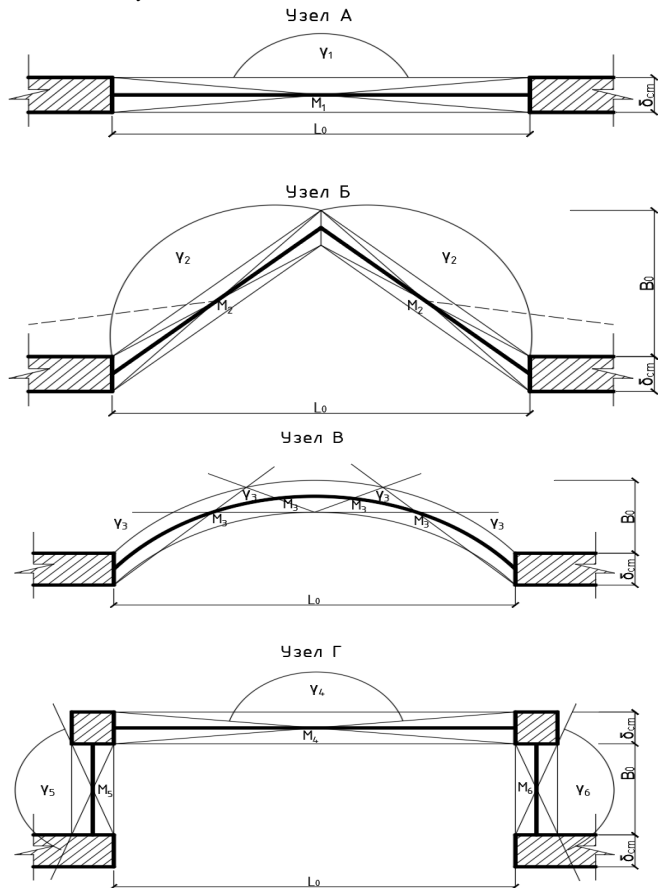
Узлы А, Б, В, Г конструкций боковых светопроемов естественного света: L_0 - длина (ширина) остекления; B_0 - вынос конструкции эркера относительно наружной стены; $\delta_{см}$ - толщина наружной стены; M_1-M_6 - расчетные инсоляционные точки; $\gamma_1-\gamma_6$ - горизонтальные инсоляционные углы; ——— граничные линии инсоляционных углов (теоретические); - - - граничные линии инсоляционных углов (натурные).
